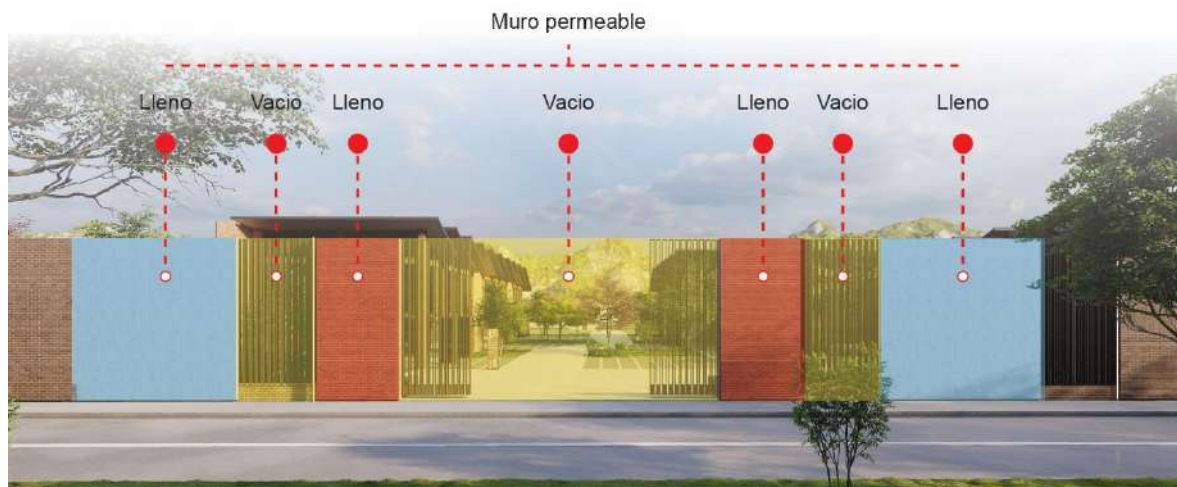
Muro permeable que permite la interacción entre el exterior y el interior
